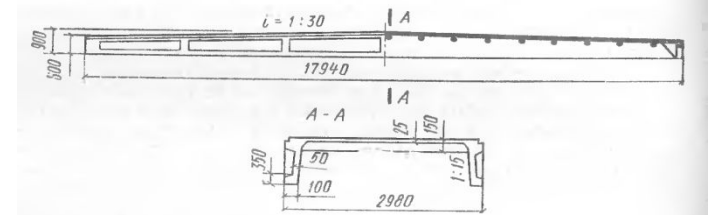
Схема ребристой плиты покрытия под малоуклонную кровлю размером 3×18 м
